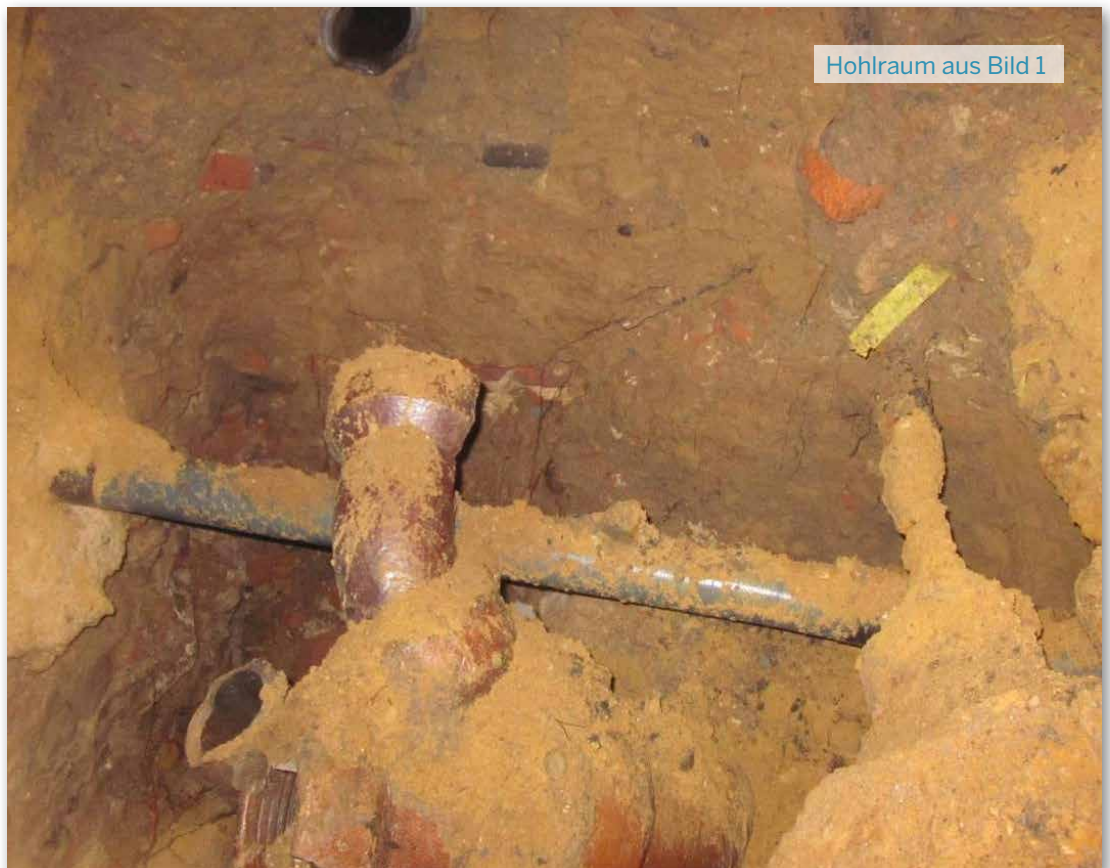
Hohlraum durch defekte Abwasserleitung - Detailansicht zu Bild 1 [Foto: Stadt Alsdorf]
